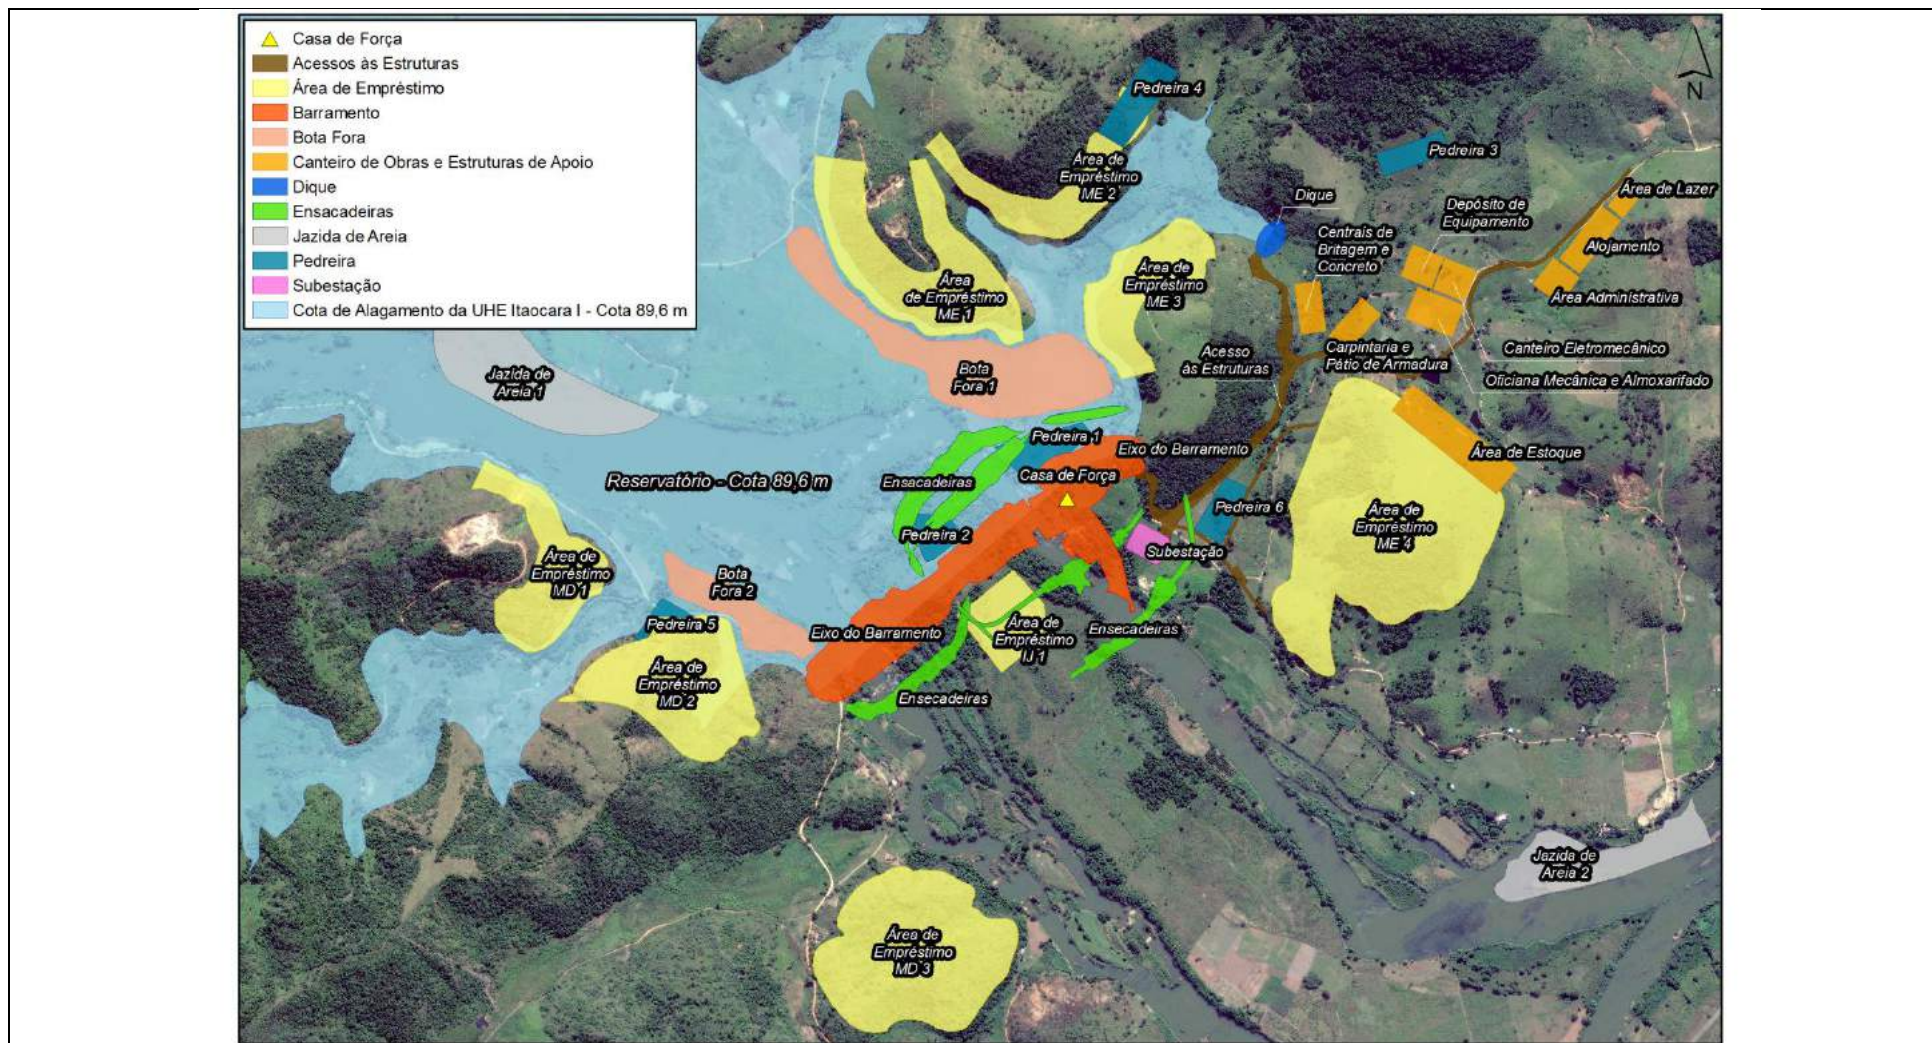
Arranjo geral das estruturas a serem construídas e do canteiro de obras da UHE Itacara I.
